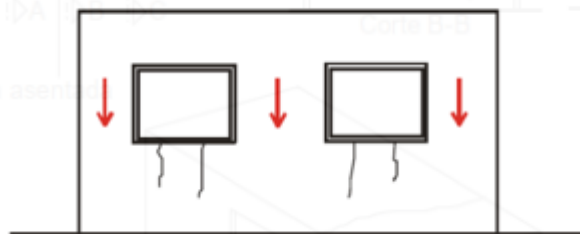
FISSURAS CAUSADAS POR RECALQUE DE FUNDAÇÕES FORA UM EIXO PRINCIPAL
